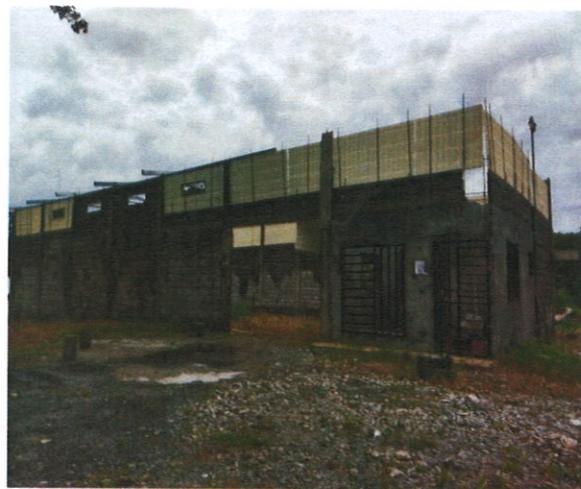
y 4. Vista del proyecto. CONSTRUCCIÓN DE GALERA.
